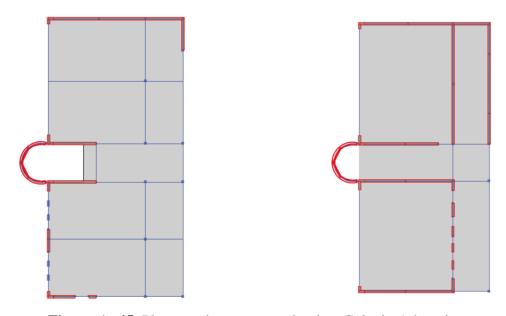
Plantas primer y segundo piso, Colegio Adventista.
